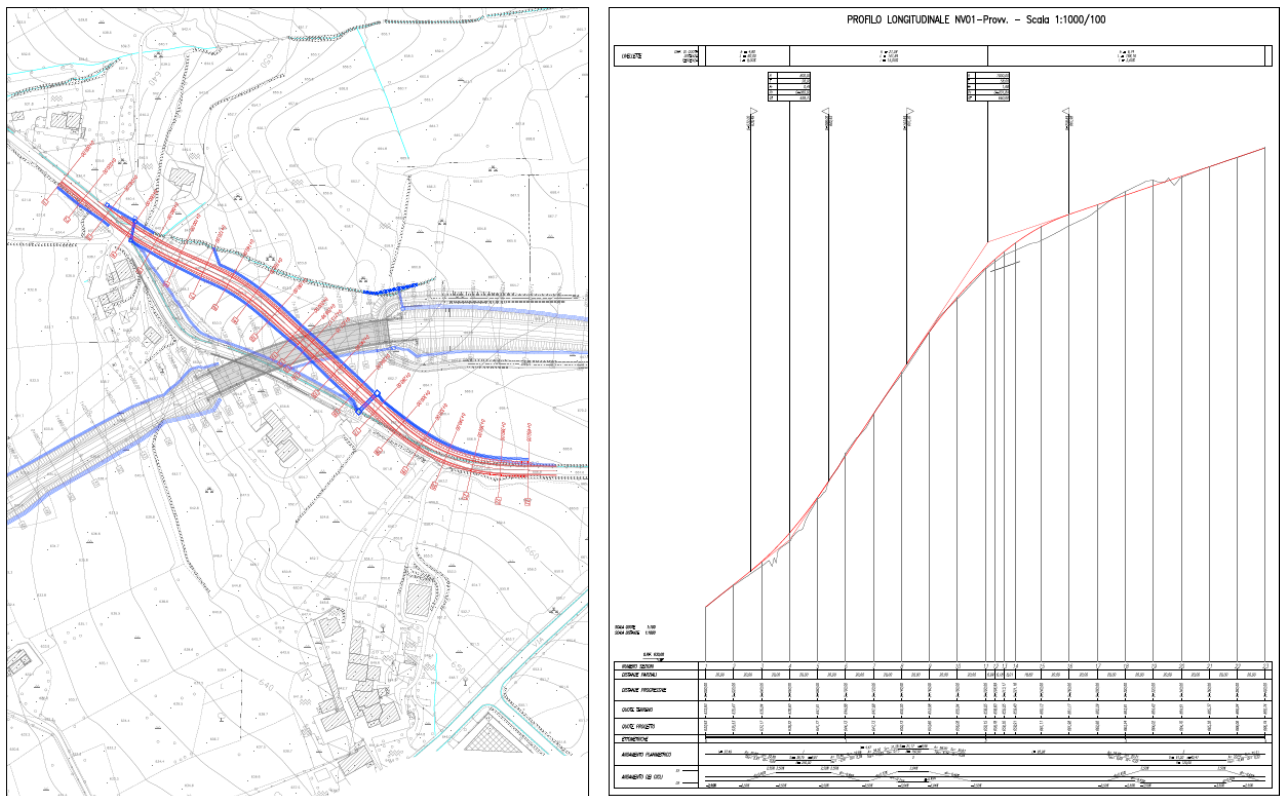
Planimetria e profilo viabilità provvisoria NVP01
